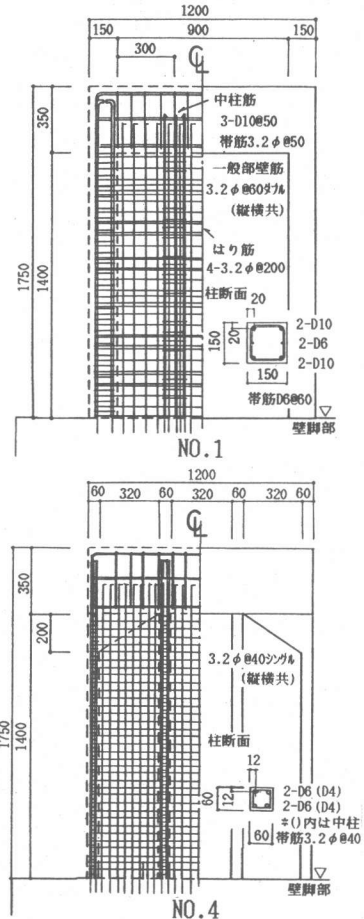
試験体形状及び配筋詳細 (NO.1, NO.4)
